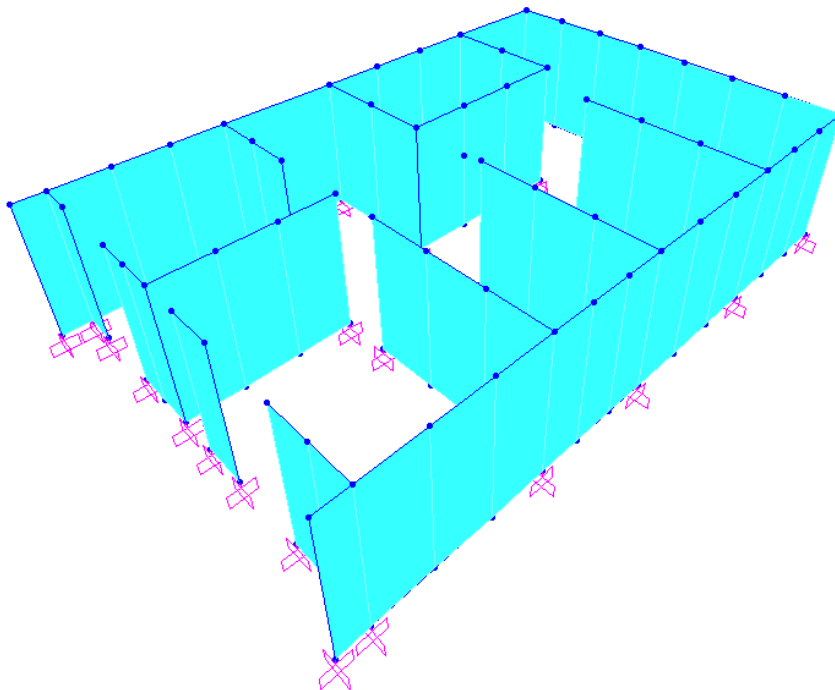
Vista 3d del modelo realizado en SAP2000 para la casa 2
